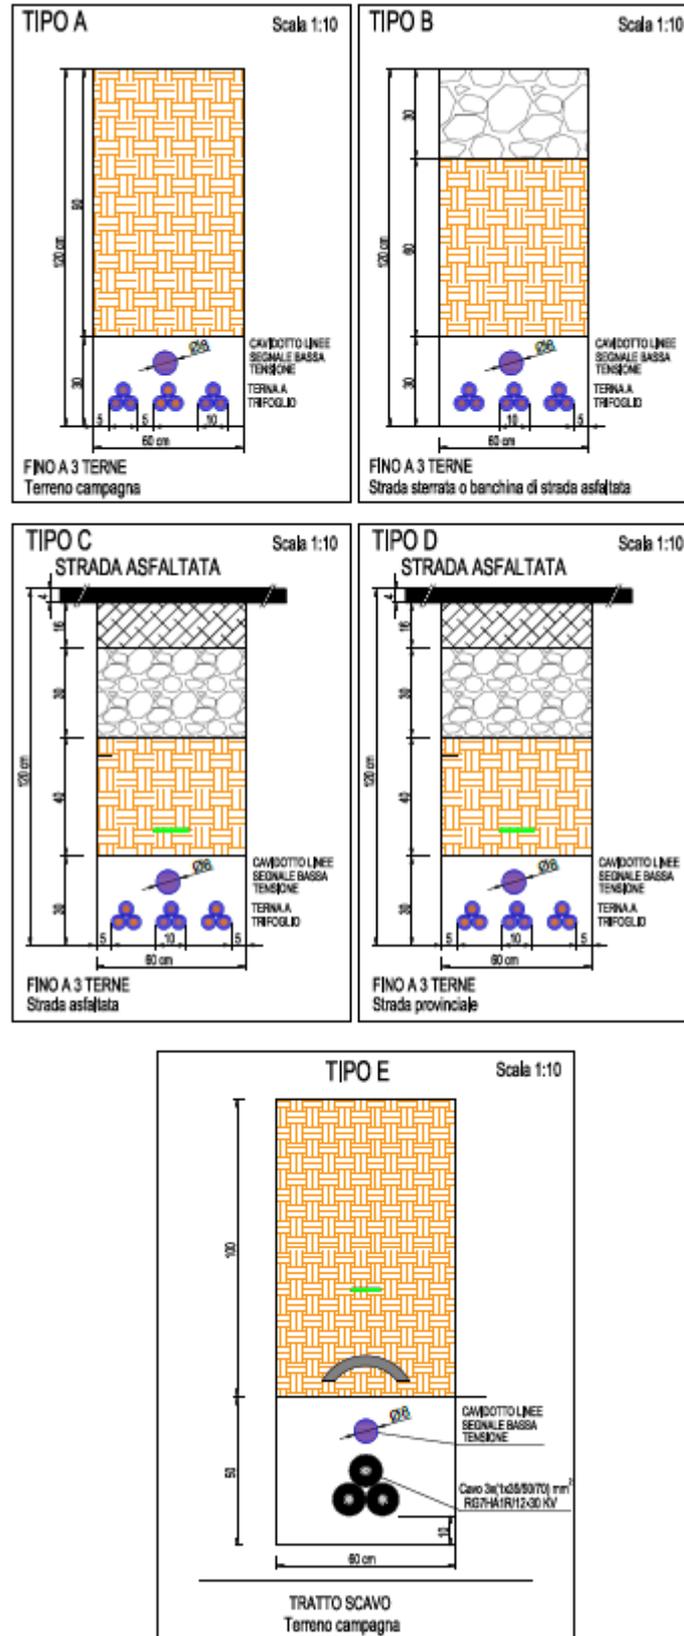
DETTAGLIO CAVIDOTTO MEDIA TENSIONE
